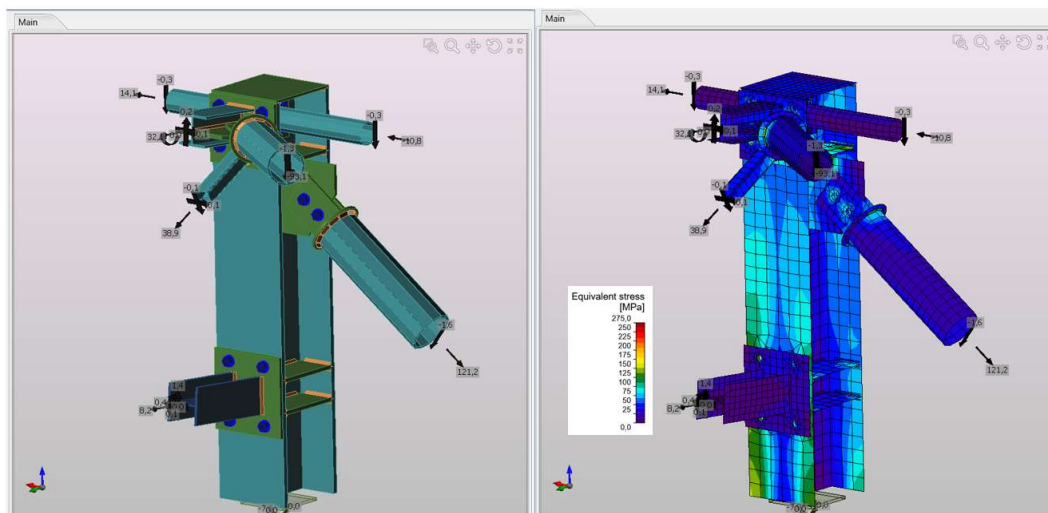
Ligação dos contraventamento de fachada aos pilares
